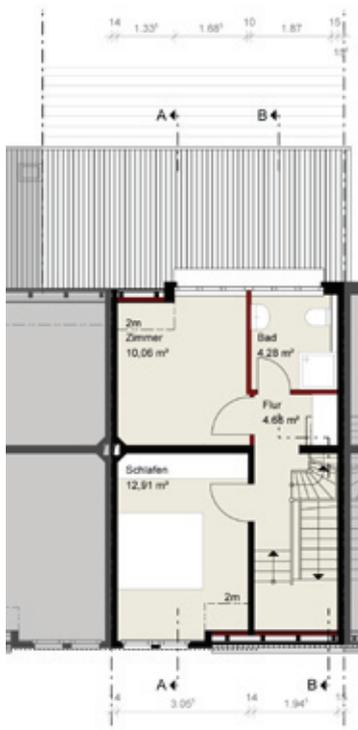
Grundriss 1. Obergeschoss Einzelhaus Variante 2.1
